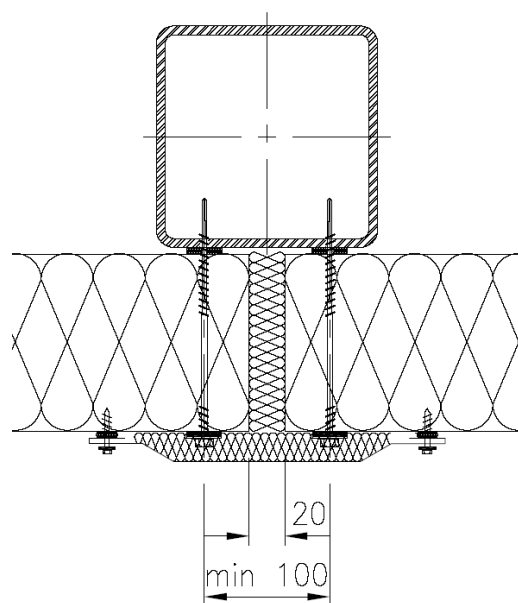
Схема оформления поперечного стыка сэндвич панелей.
